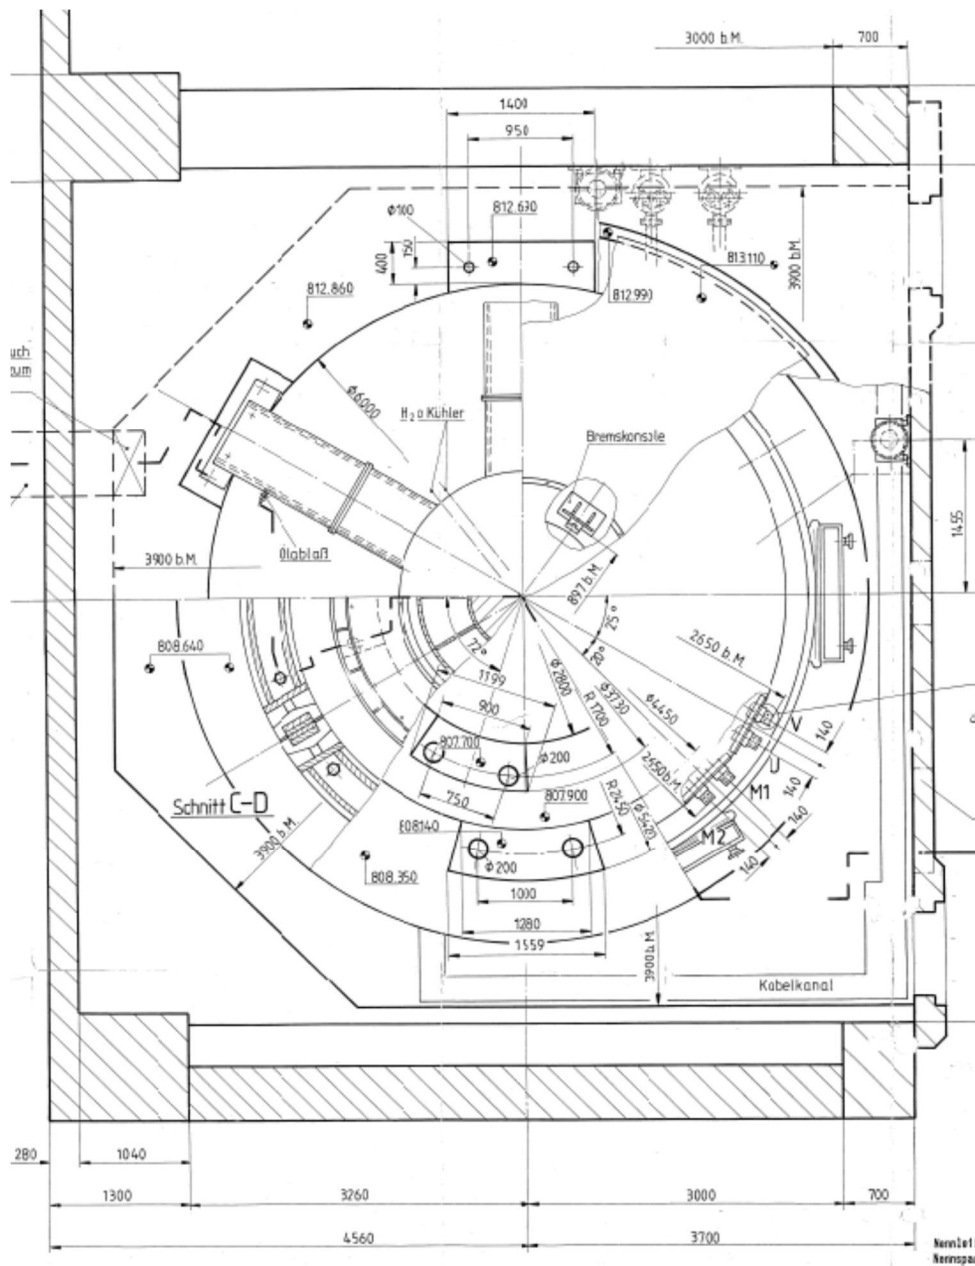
Massbild Grundriss MG2 als Illustration
